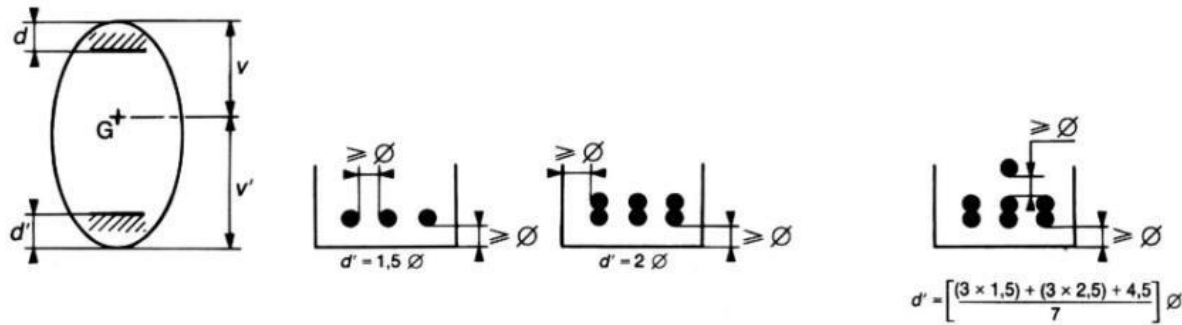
Dispositions constructives des câbles de précontrainte.
